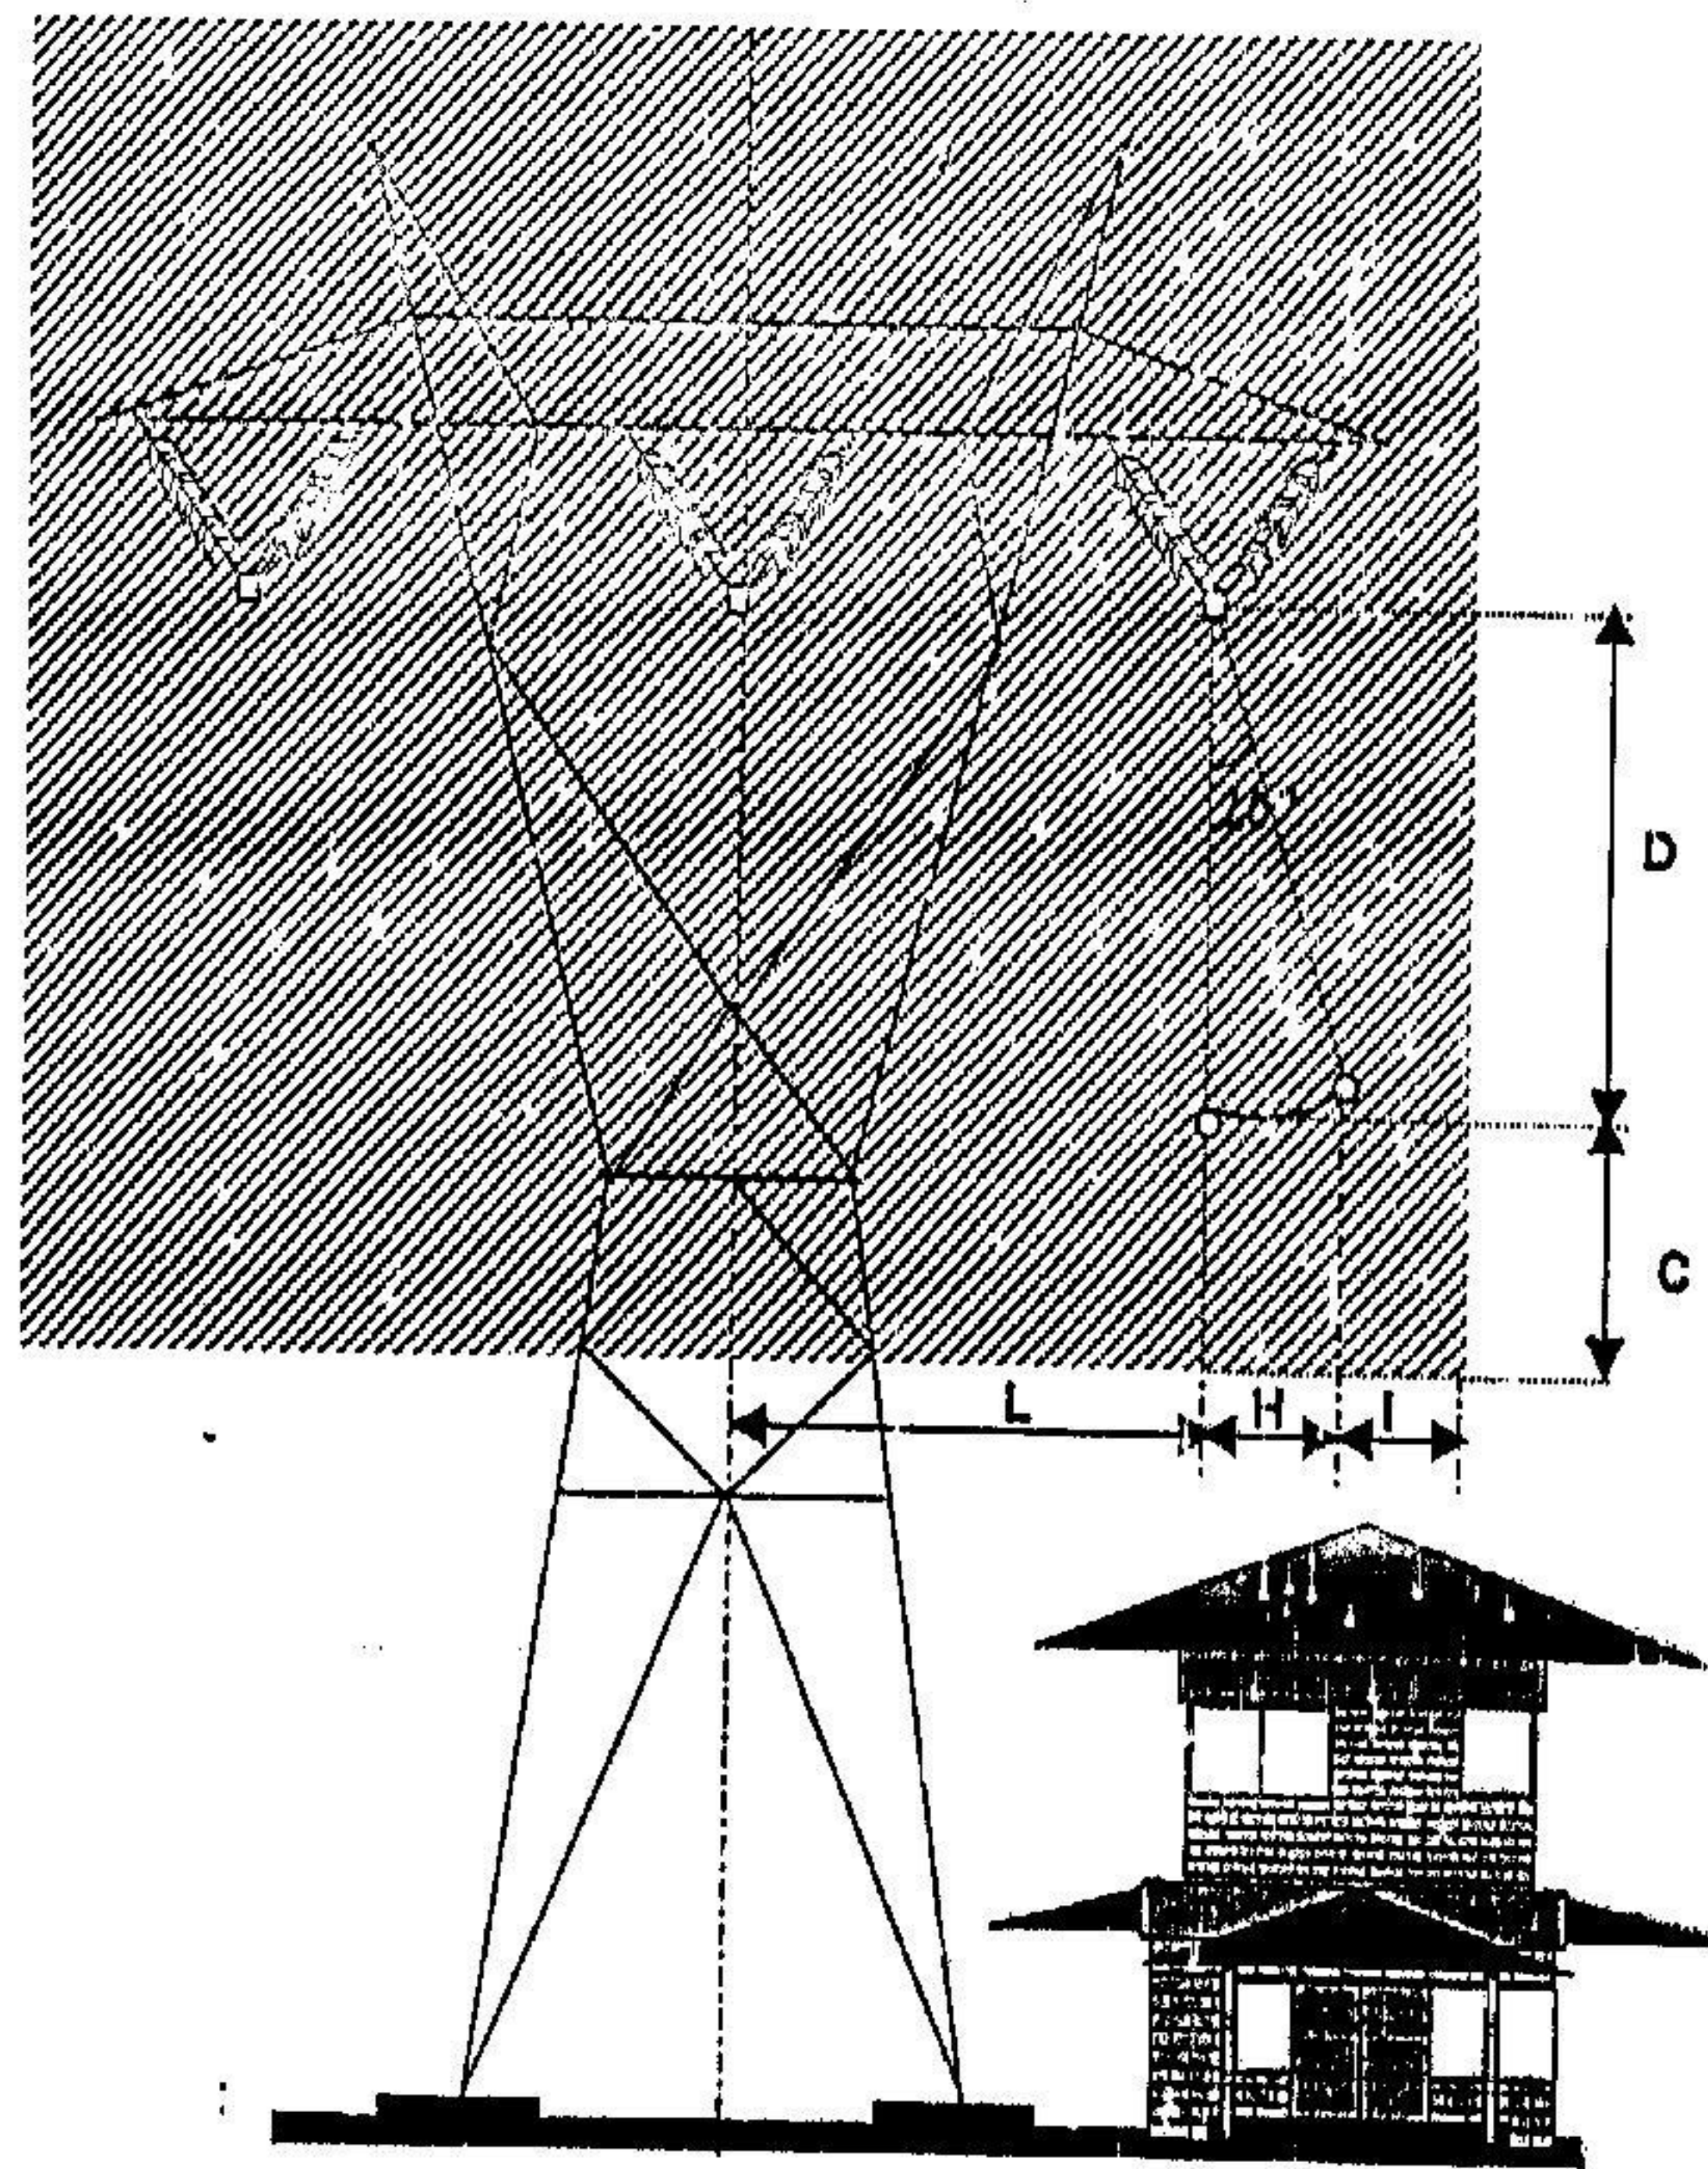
Ruang bebas SUTT 66 kV dan 150 kV tiang baja
